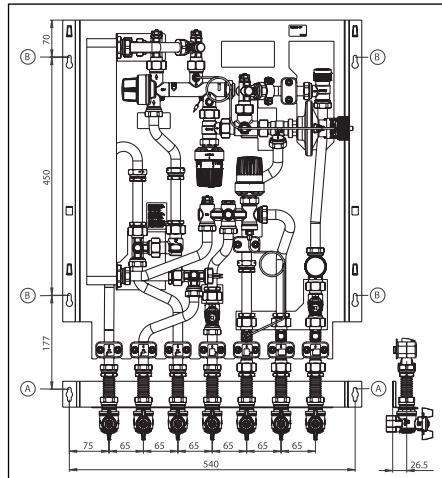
Schema di collegamento barra di fissaggio valvola a sfera Versione GSWB - 1341182
